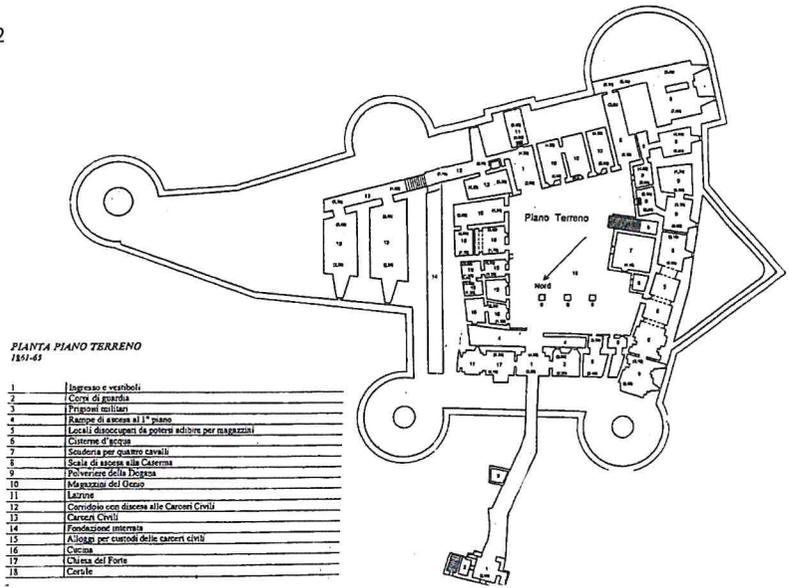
Planimetria del 1861 del piano della corte interna del Castello.
